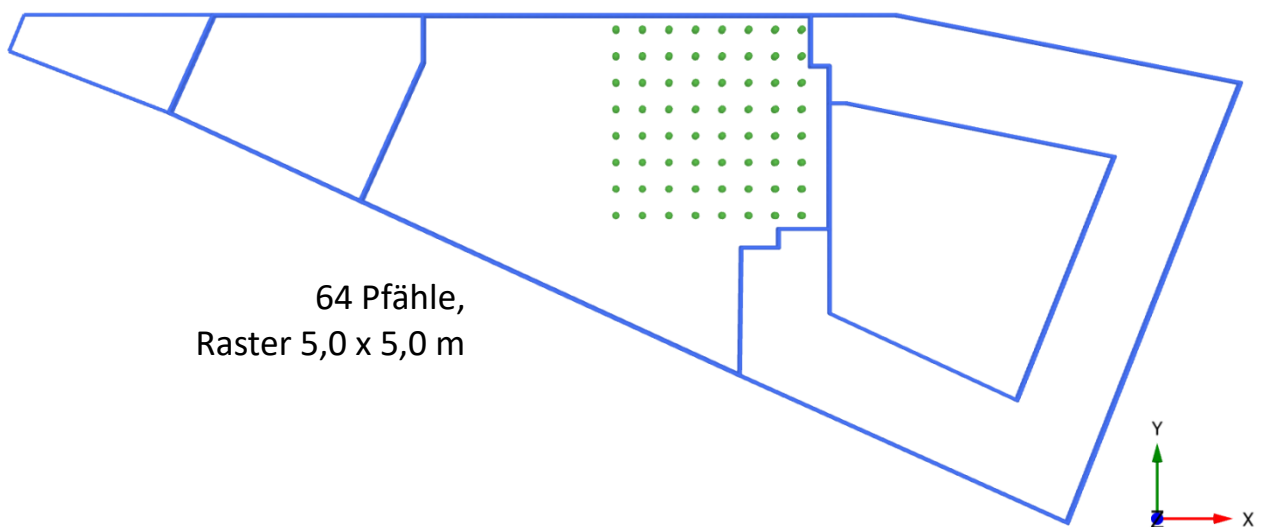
Lage der KPP-Pfähle im Grundriss
